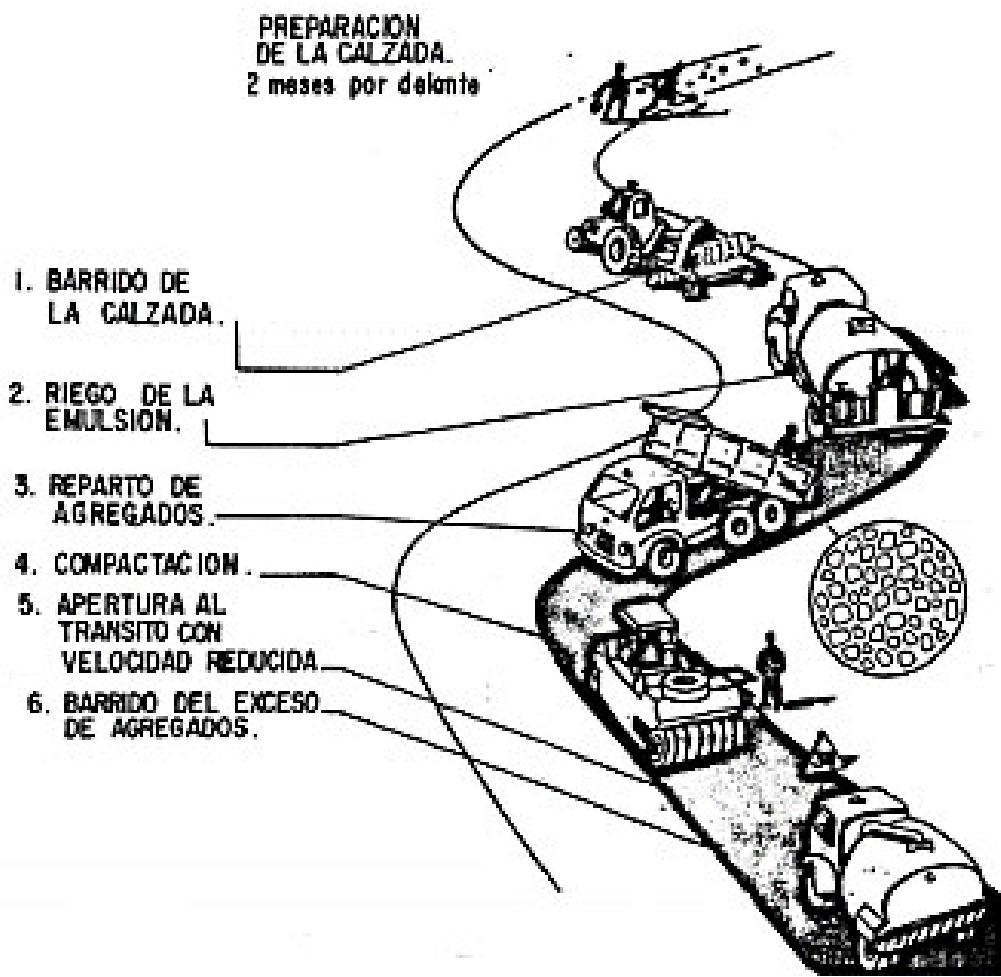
Tratamiento superficial de pavimento Slurry Seal
